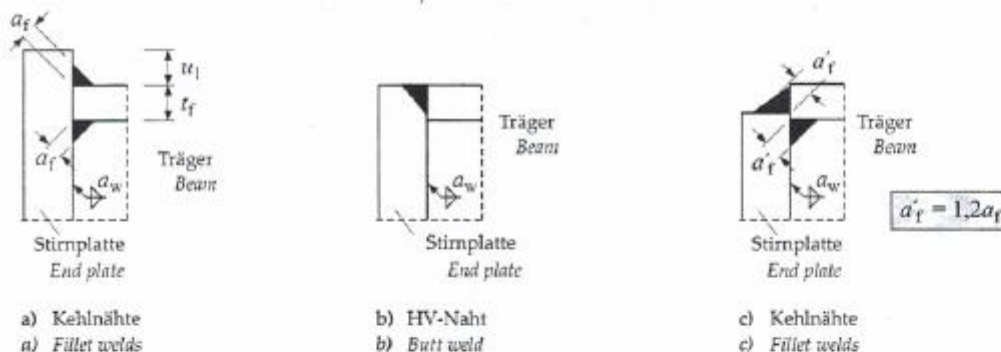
Ausführungsmöglichkeiten der Schweißnaht bei bündigen Stirnplatten
